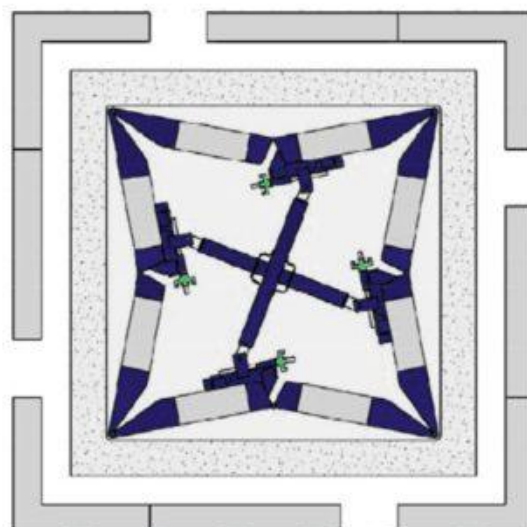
Схема работы опалубки шахт на шарнирах (монтаж/демонтаж)
